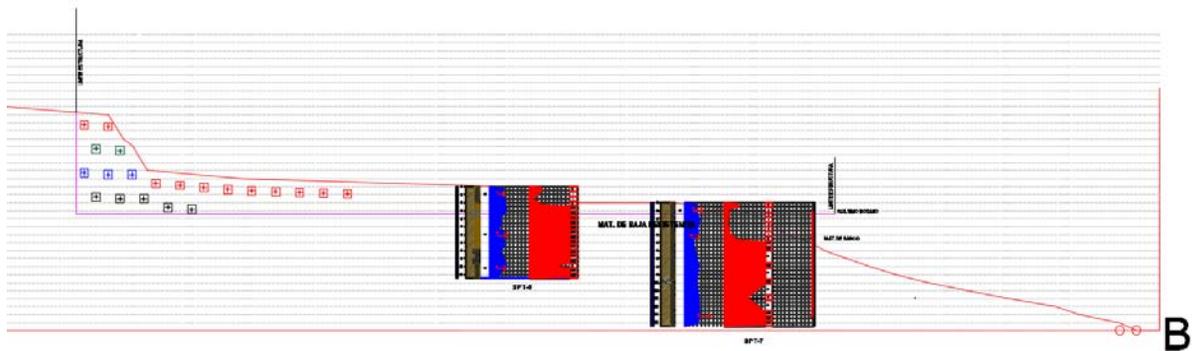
CORTE E-B', SISTEMA DE ANCLAJE
